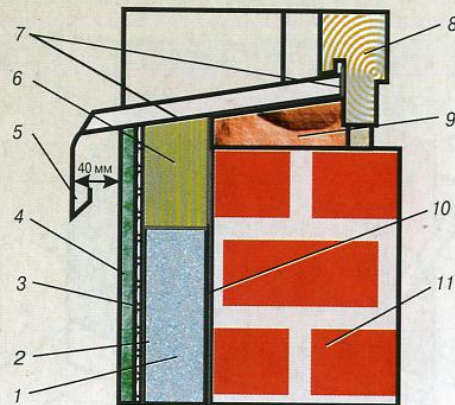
ФРАГМЕНТ ПРИМЫКАНИЯ УТЕПЛЕННОГО ФАСАДА К ПРОФИЛЮ:
